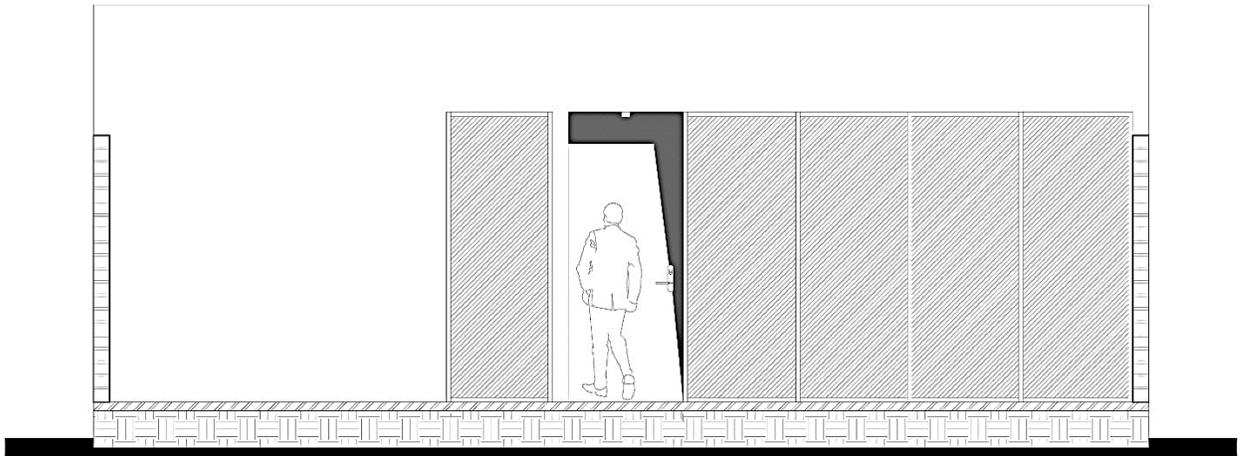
Corte longitudinal esquemático de vivienda adaptable
